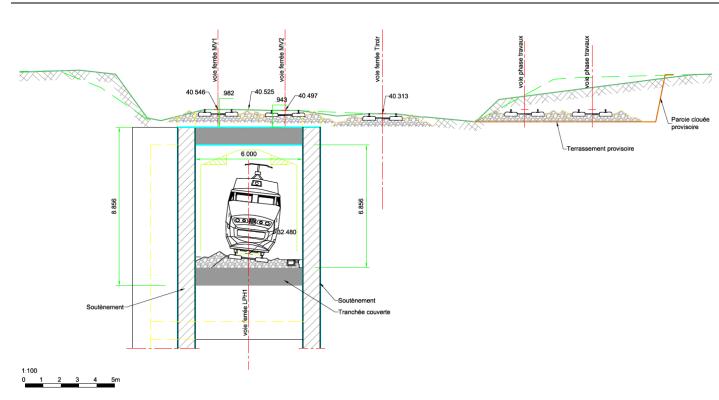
Coupe 2 - Vue en coupe du terrier (source : Egis, 2021)
